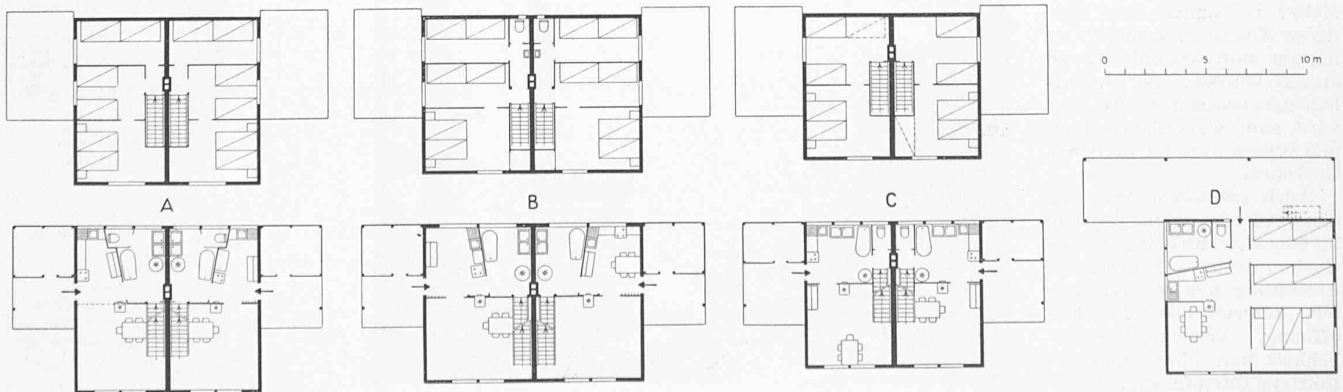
Holzhaus-Typen A, B, C und D von Arch. OTTO SENN (Basel). Grundrisse vom Erdgeschoss und Obergeschoss. — Masstab 1 : 333
